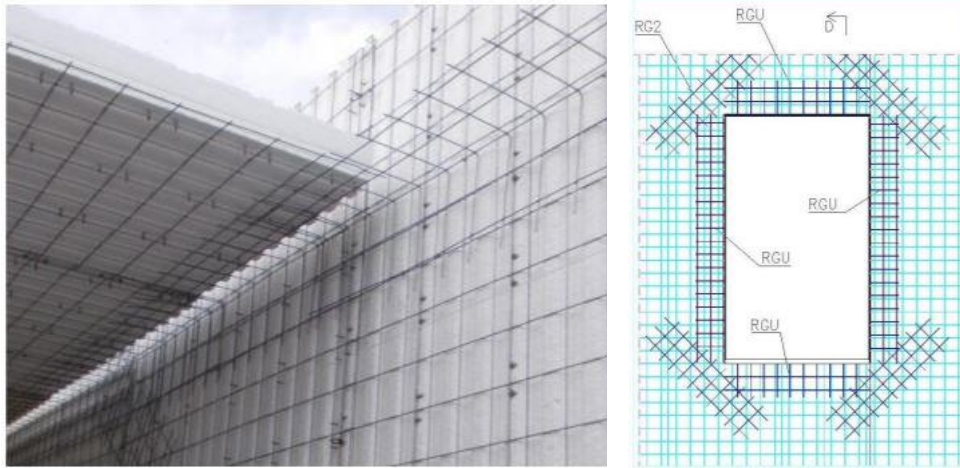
Refuerzos en esquinas y borde de losa.
